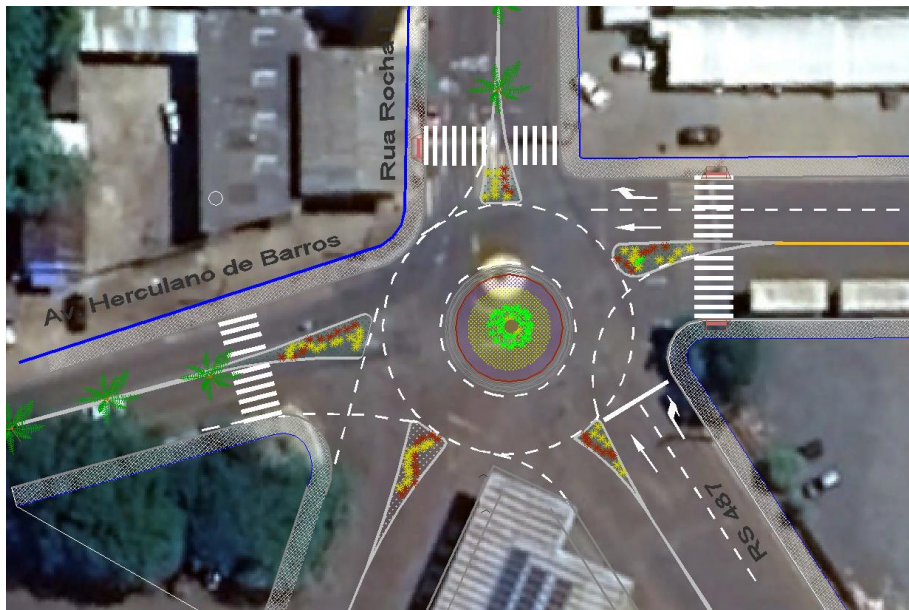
Intervenções propostas para a conexão da Rua Rocha Loires com a Rua Herculano de Barros
